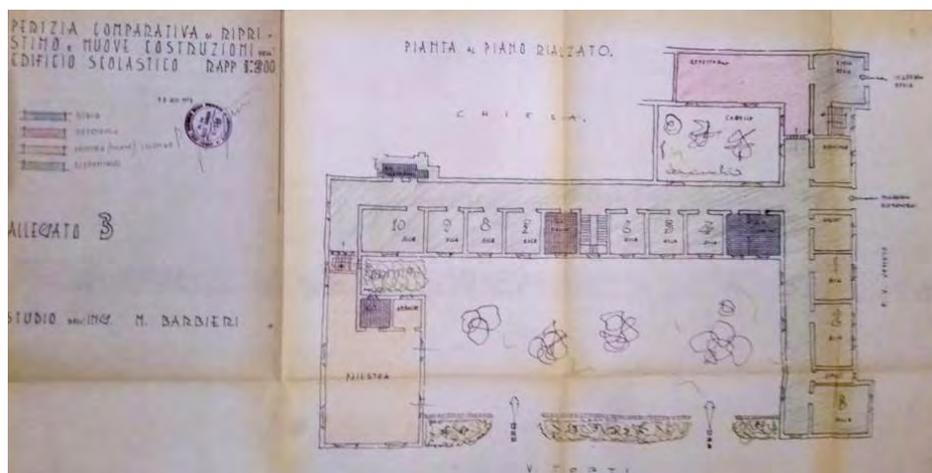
Disposizione finale degli spazi nel progetto dell'Ing. Mario Barbieri (piano terra)
